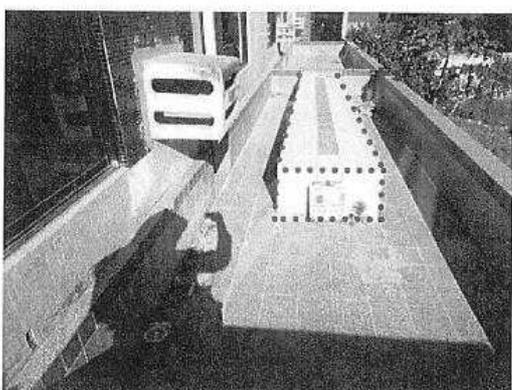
Elemento, tipo "mesa" construído sobre a laje, sobrecarregando a estrutura. Vista de oeste para leste.
